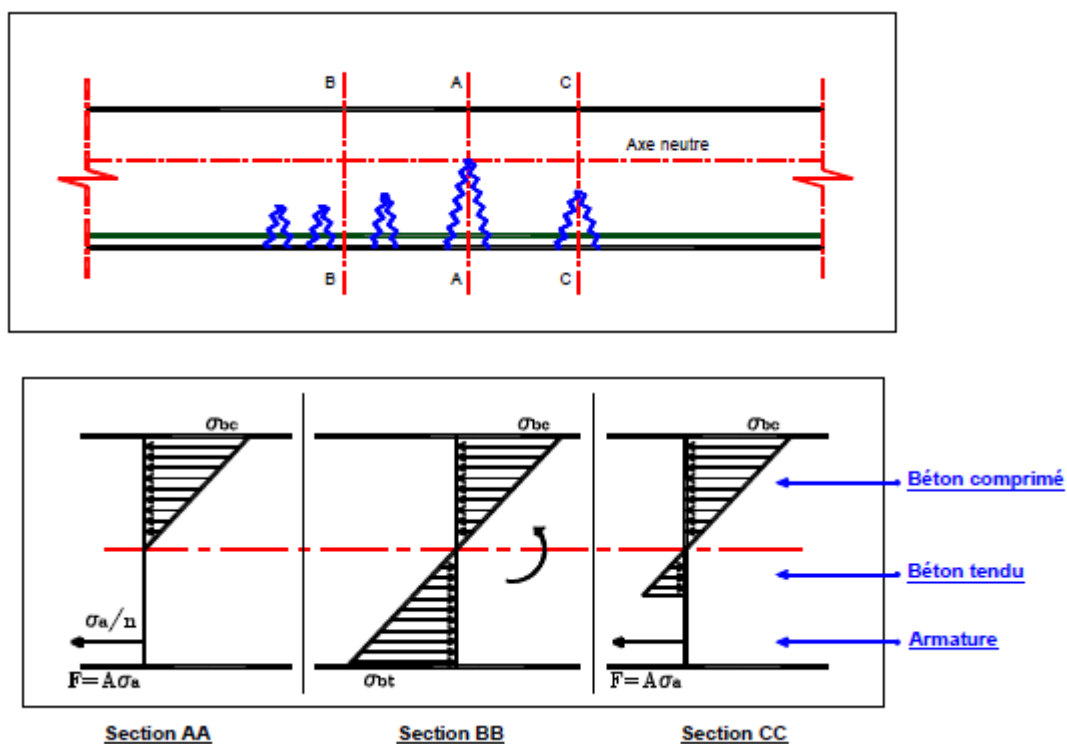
Schéma de fissuration en fonctionnement normal.
